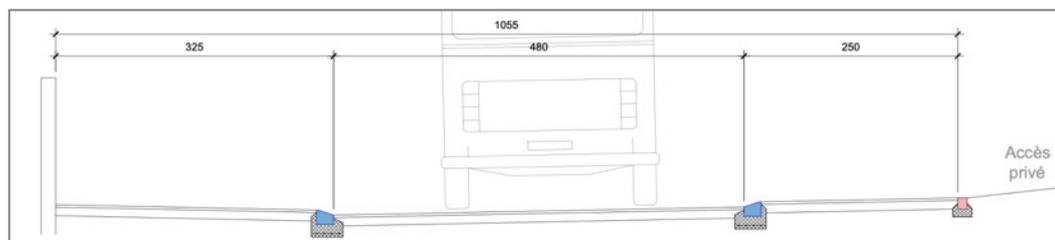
secteur II – gabarit au droit des accès privés (extrait du plan des surfaces MCR)
